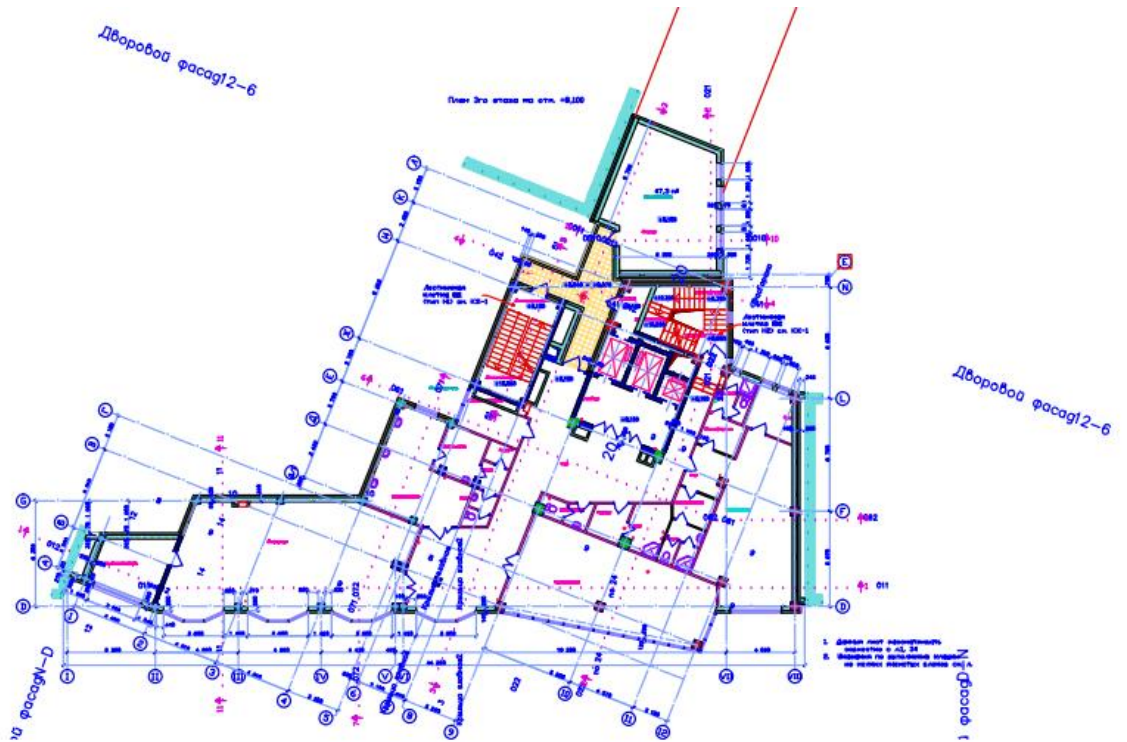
План третього поверху на відмітці +8,100
